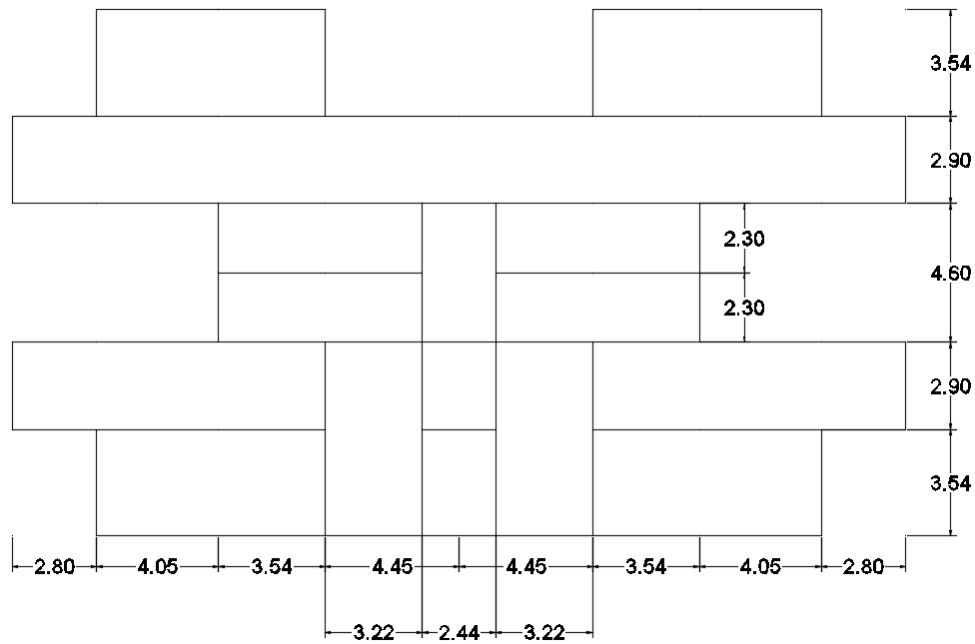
Planta tipo nivel 1-4 de modelo digital del bloque 11 de San Fernando (Fuente: Ministerio de la Vivienda, 1973)
